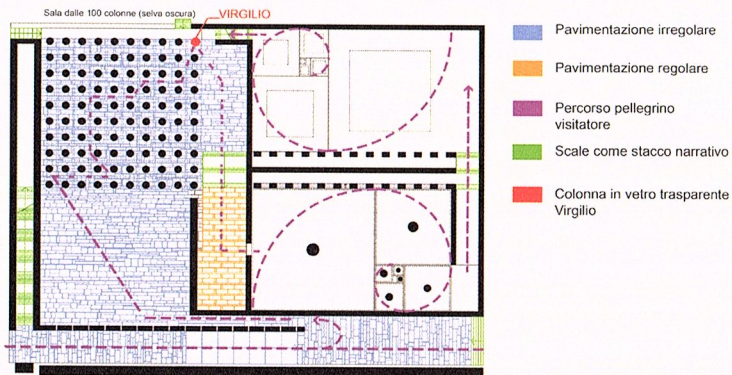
Pianta del piano terra: corrispondenze tra testo scritto e architettura
